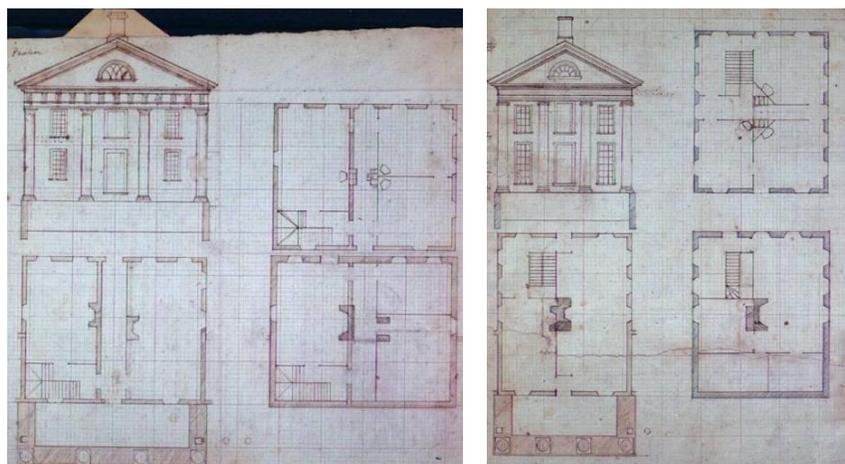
Pavilhão 1; Fig.: 90 - Pavilhão 2;
